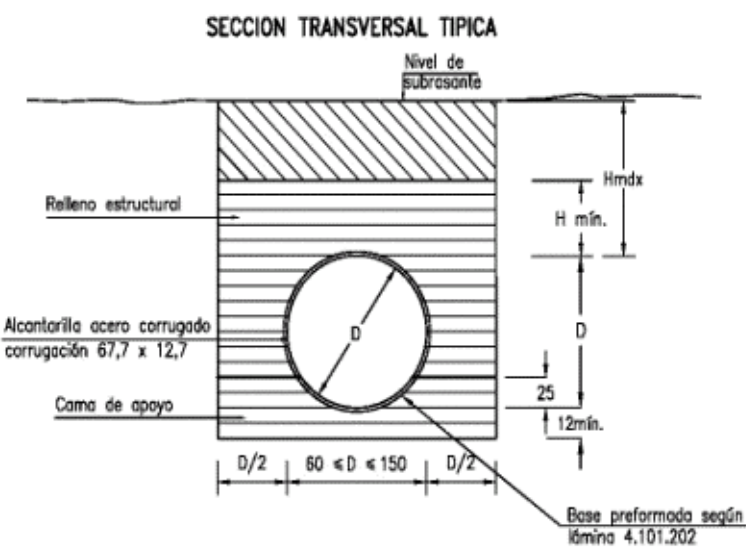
Sección típica, tubo acero corrugado 67,7 x 12,7.
